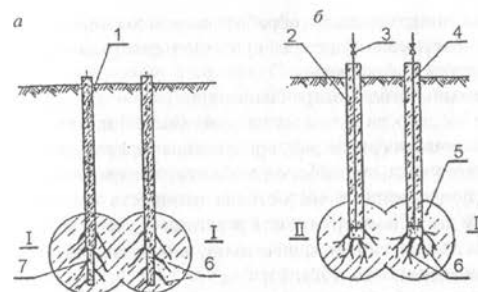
Армирование оснований сваями-инъекторами: 1 — забивная свая; 2 — буронабивная свая; 3 — вентиль; 4 — нагнетательная труба; 5 — закрепленный грунт; б — пространственная система из цементного камня; 7 — лидерная скважина
